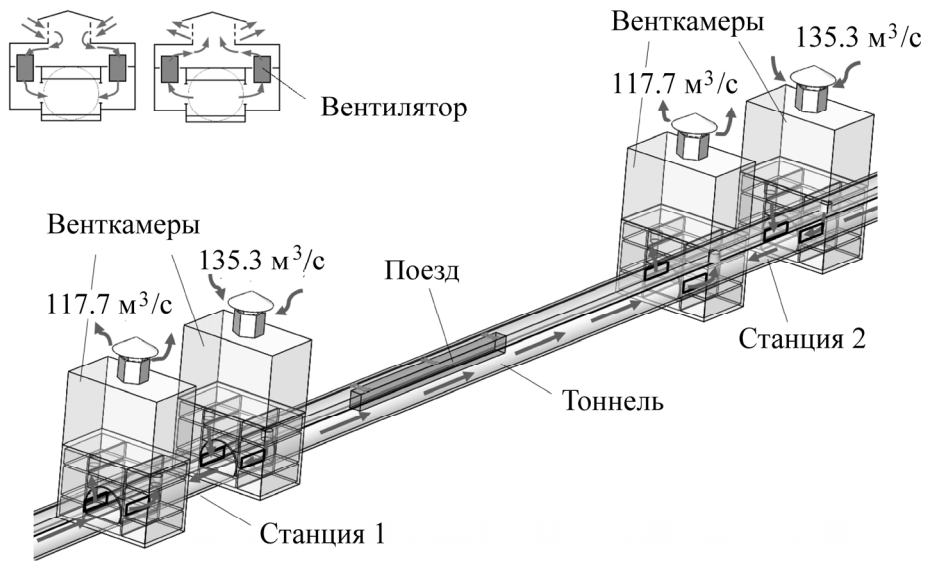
Схема работы системы тоннельной вентиляции в штатном режиме с расходами воздуха через подающие и удаляющие вентиляционные камеры
